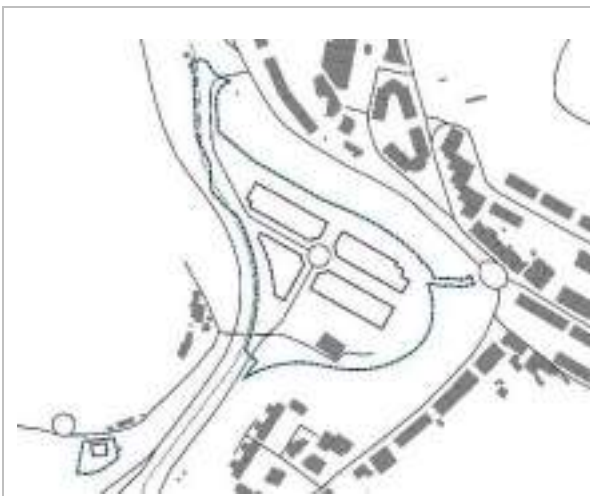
Planta de ordenación de la Alternativa 0 (descartada)
